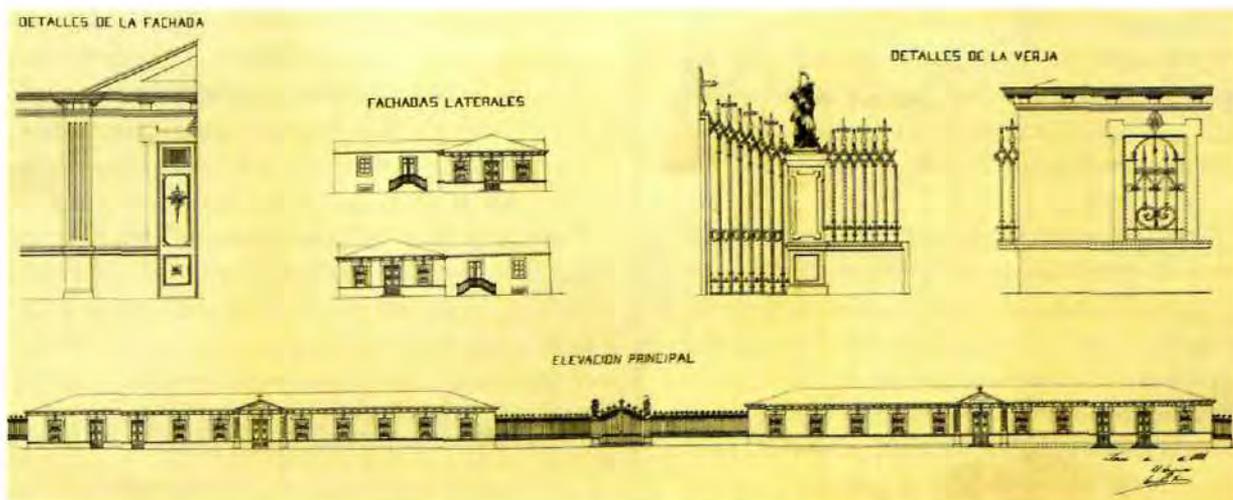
Detalles de la fachada, fachadas laterales, verja y alzado de la fachada principal. Ingeniero Riera. 1888
